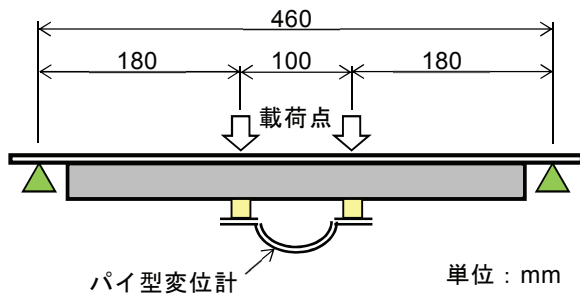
曲げ荷荷によるひび割れ導入方法
